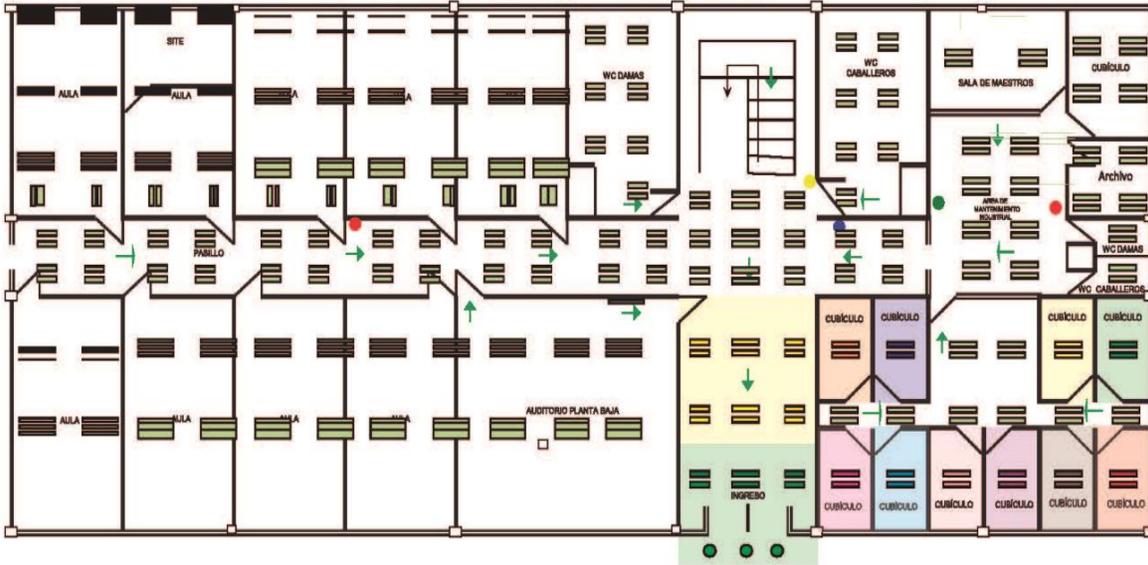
Edificio Docencia “I”, Planta Baja
